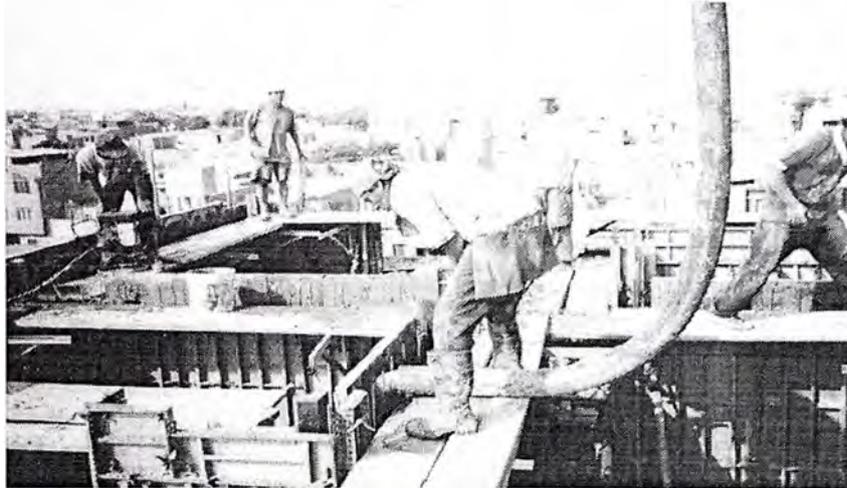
Encofrado de muros con refuerzo de acero convencional
